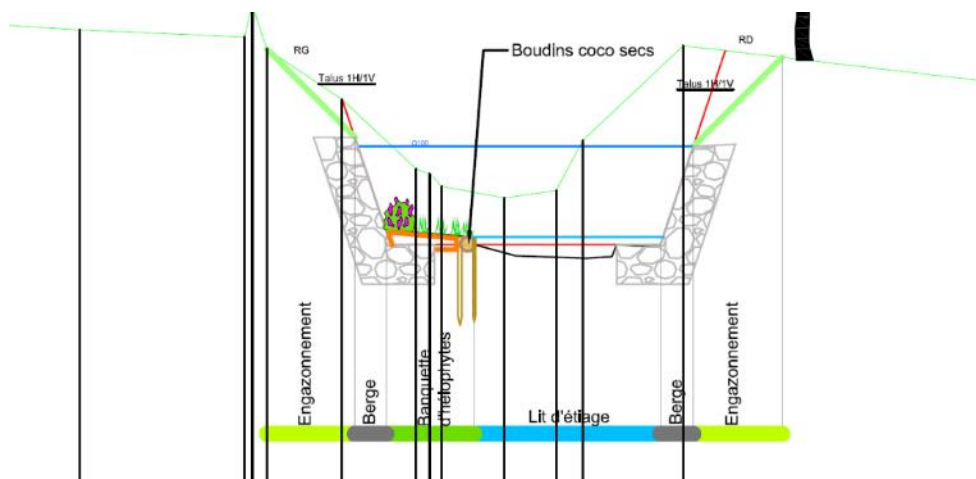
Exemple de profil en travers au droit de la zone urbanisée
